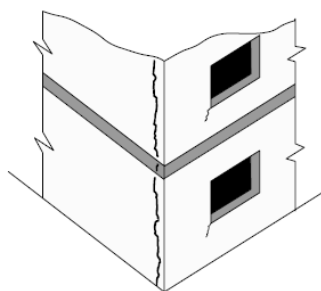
Expansão dos tijolos por absorção de umidade provoca o fissuramento vertical da alvenaria. (Fonte: THOMAZ)
